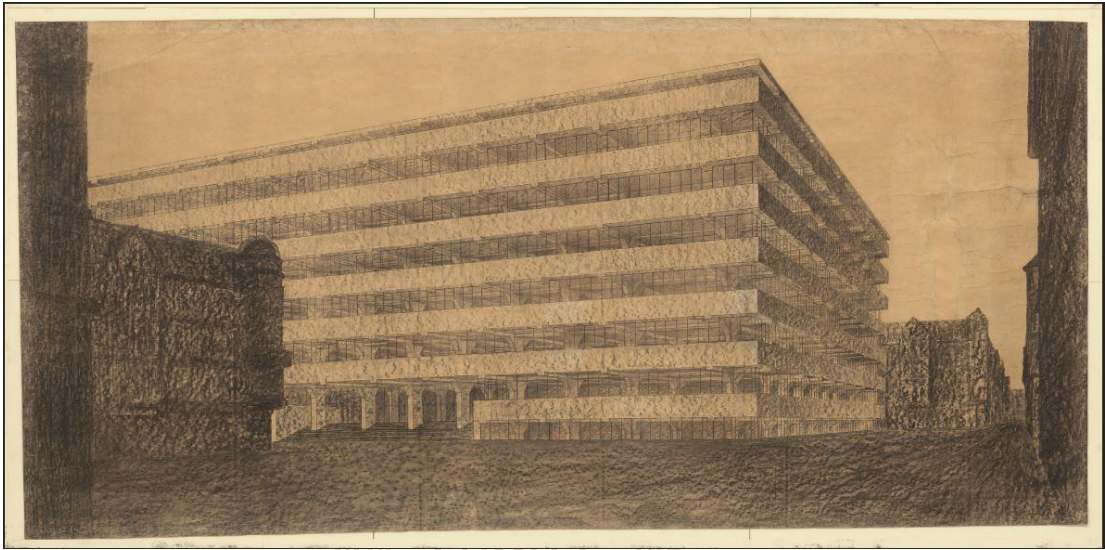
71 ทศนียภาพอาคาร The Reinforce Concrete Office Building
